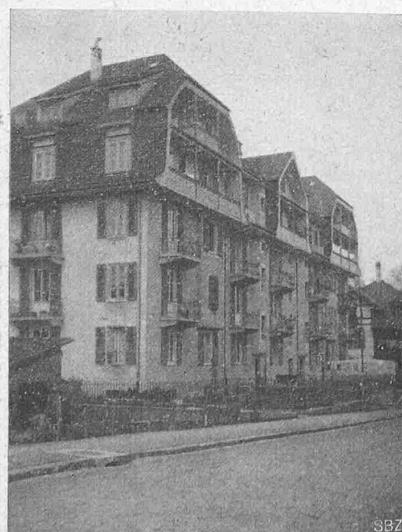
Fünfgeschossige Neubauten mit Vorgarten, laut Baureglement.
